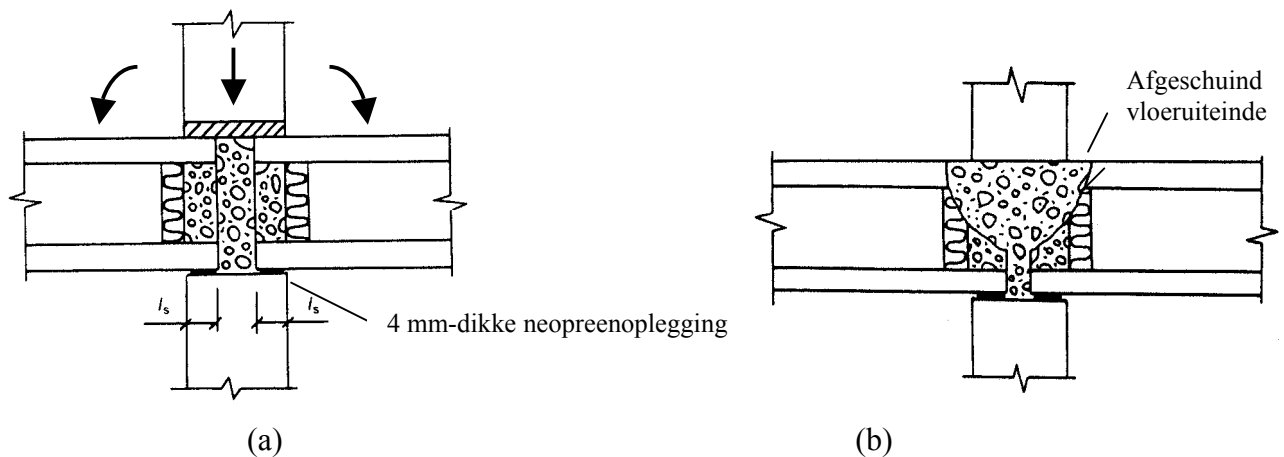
Detaillering van de oplegging om toevallige inklemmingen te vermijden
